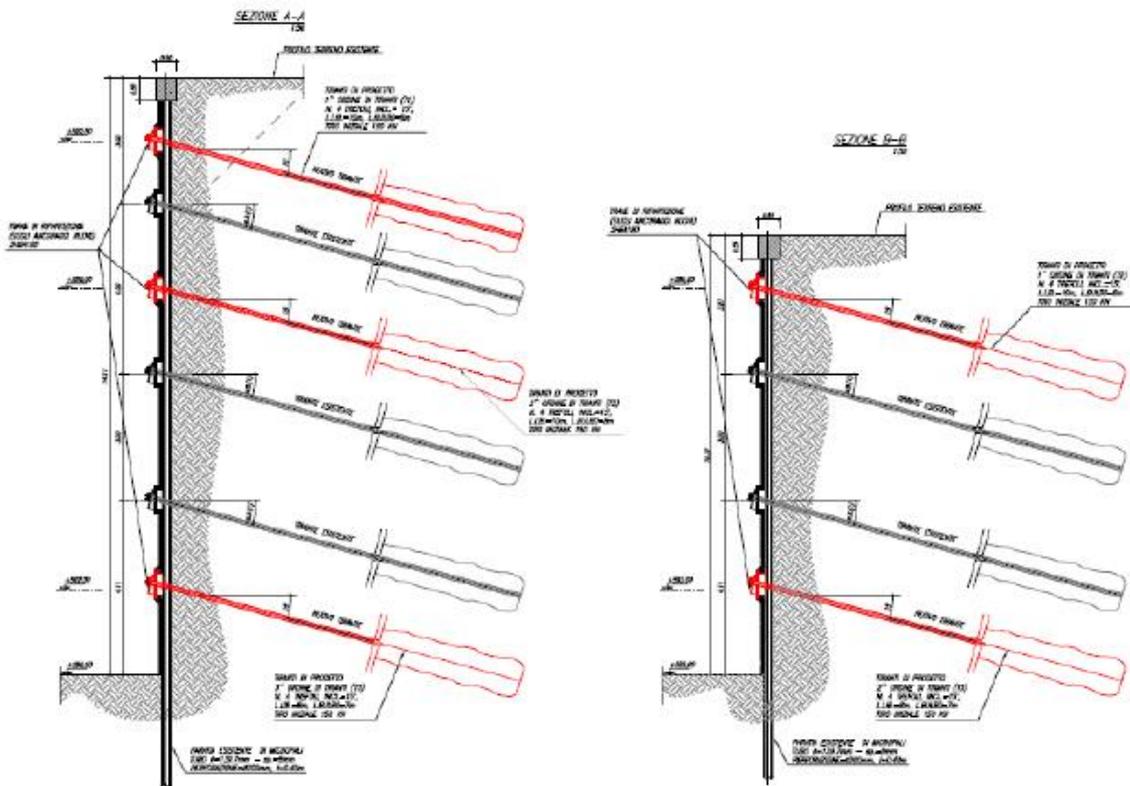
Galleria Guinza- Imbocco lato Umbria – Stato di progetto – Sezioni
